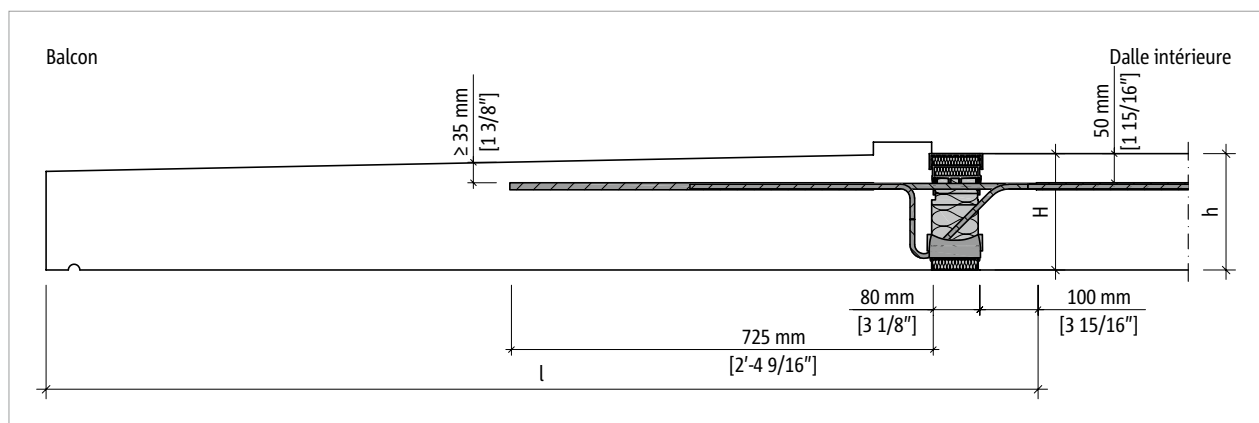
Schöck Isokorb® T Type CK : Recouvrement de béton CV50 (2") avec dalle de balcon inclinée
